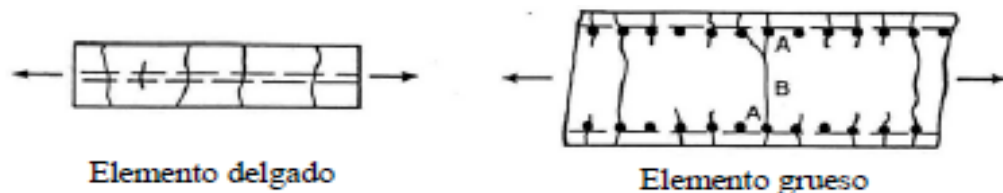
Fisuras por Tracción. Fuente Ottazzi Pasino.
